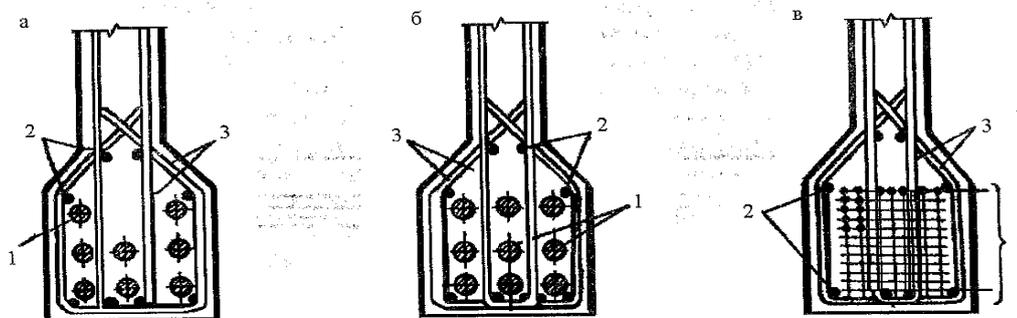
Размещение напрягаемой арматуры в растянутой зоне балок
